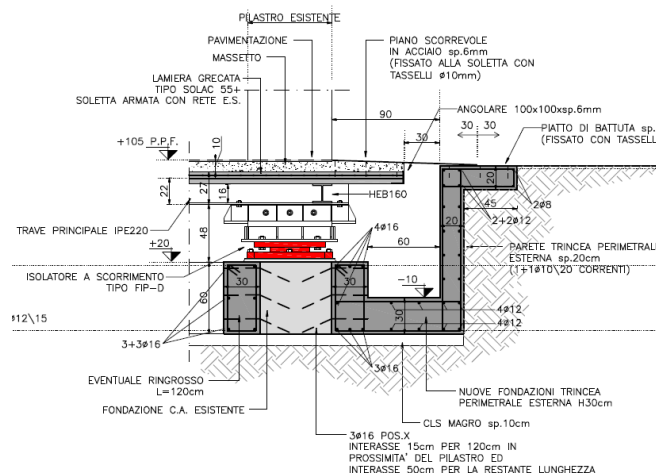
Particolare dell'intervento in fondazione per la realizzazione dello scannafosso perimetrale e del giunto sismico tra struttura isolata e a base fissa.
